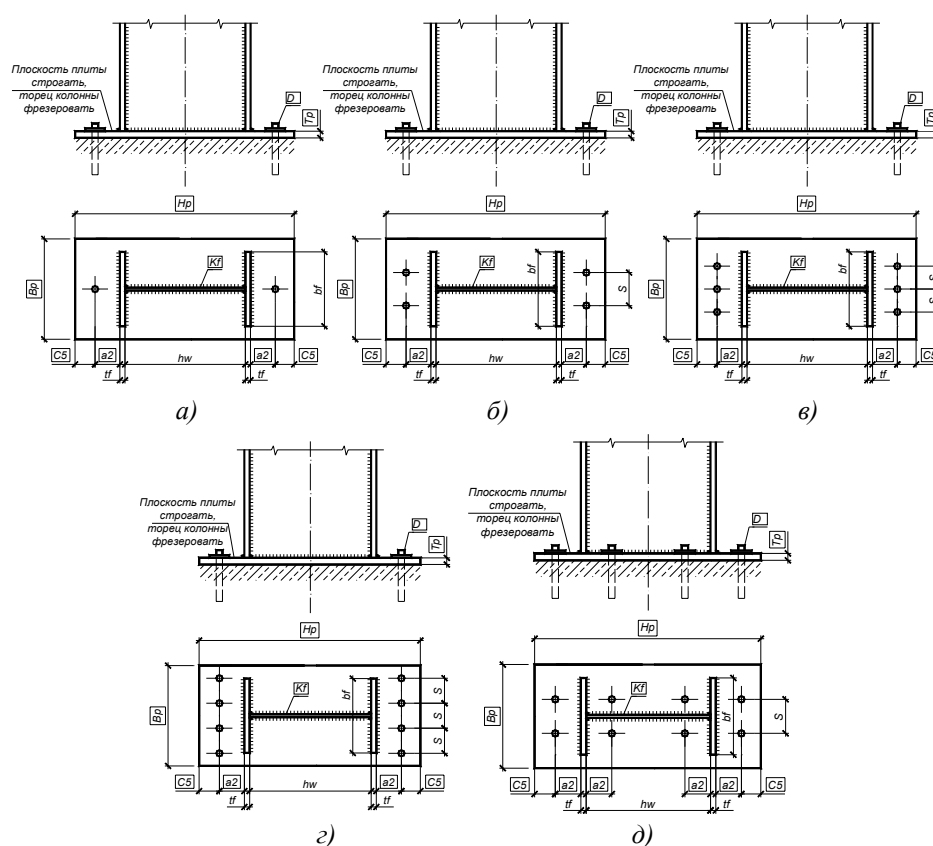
Типы конструктивных решений узлов жестких баз колонн с фрезерованным торцом.
